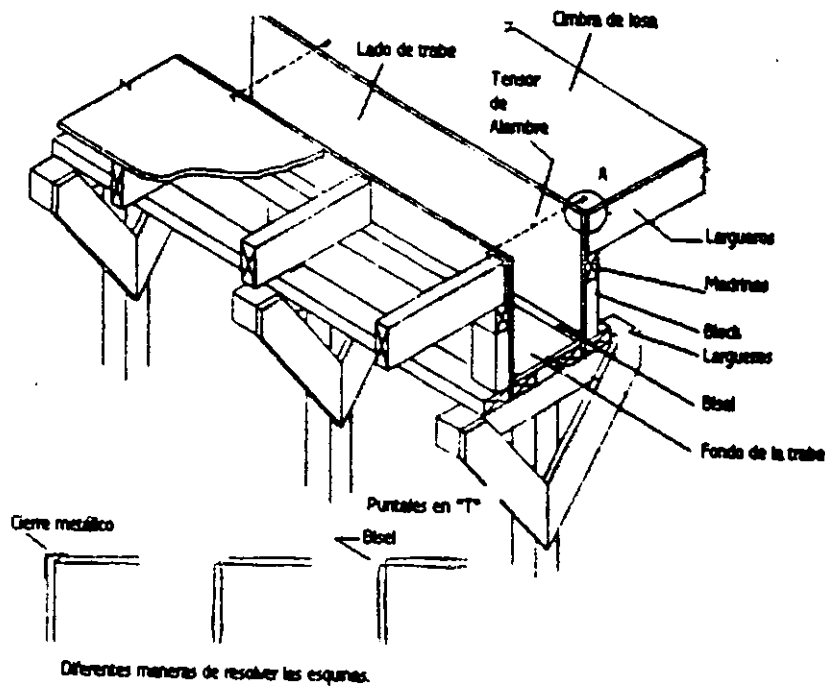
Arreglo típico de cimbra para trabe y losa.
